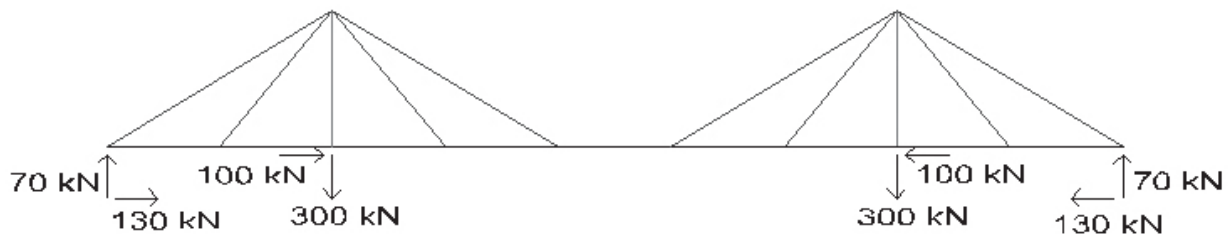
Levantamento dos esforços utilizados no dimensionamento da fundação
